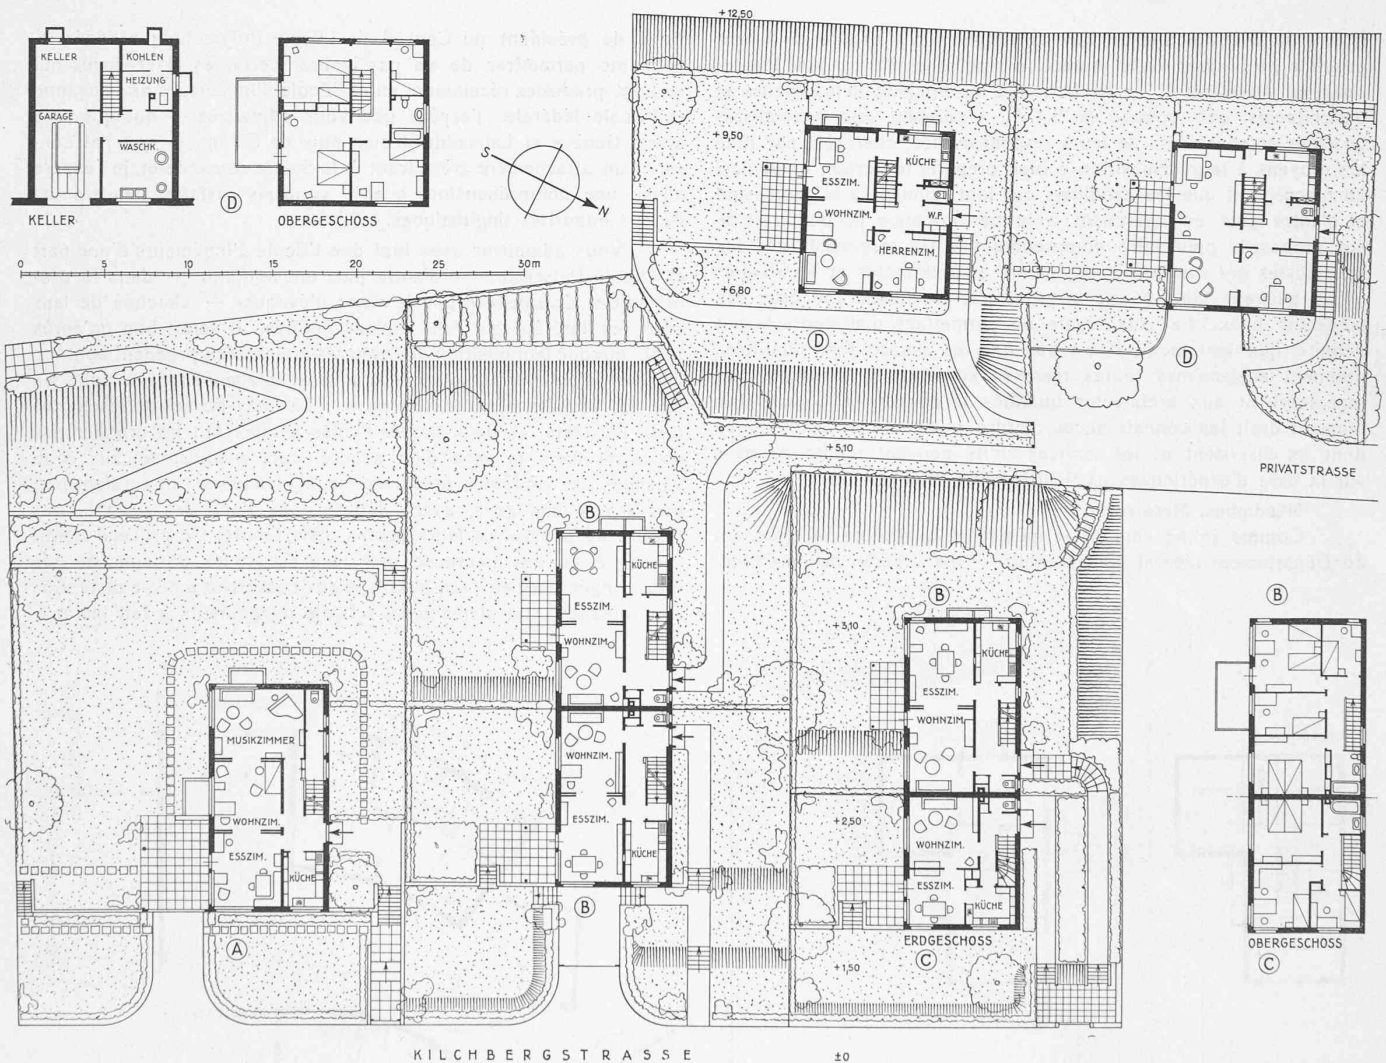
Gruppe von Einfamilienhäusern an der Kilchbergstrasse in Zürich 2. Arch. Laubi & Bosshard (1929/30). — Erdgeschoss-Plan mit Grundrissen 1 : 400.
